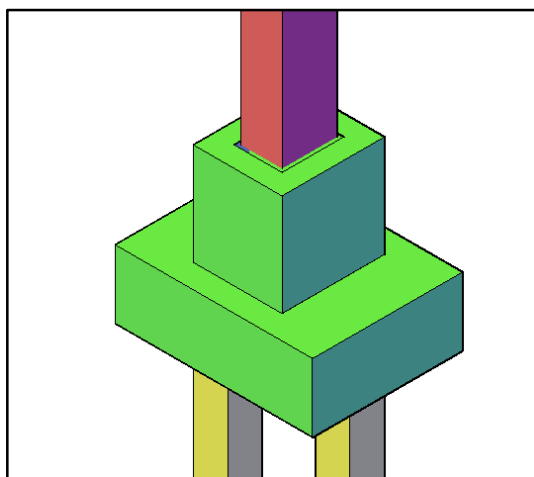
Vista en 3D del dimensionamiento de la zapata. Fuente del autor.
